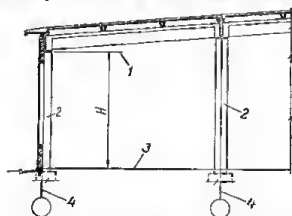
Высота крайних пролетов зданий без мостовых кранов при наружном отводе воды:
